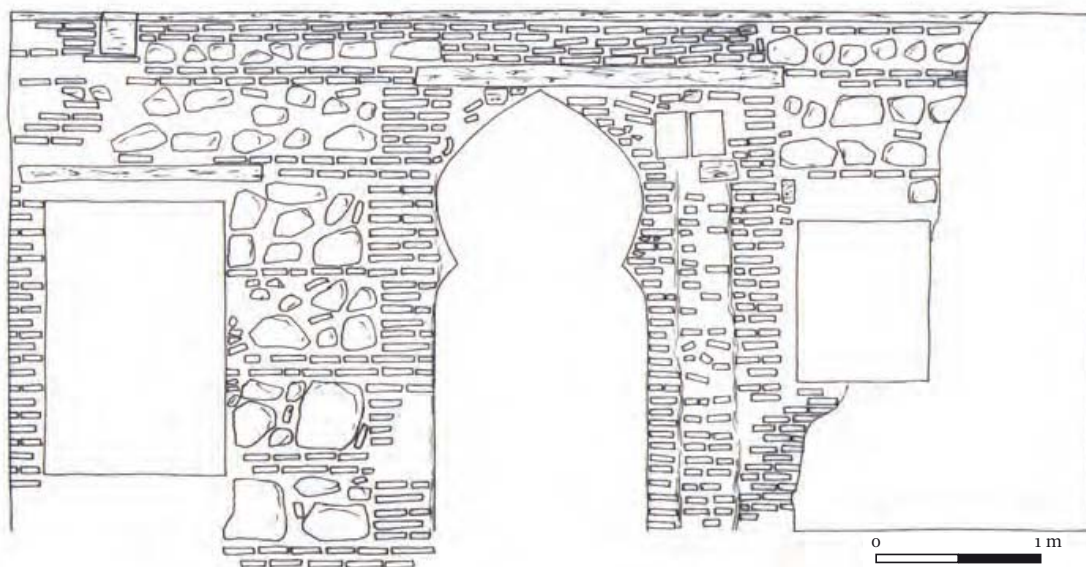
Calle de Santa Úrsula 11. Tercer muro (fachada interior sur del segundo patio).
